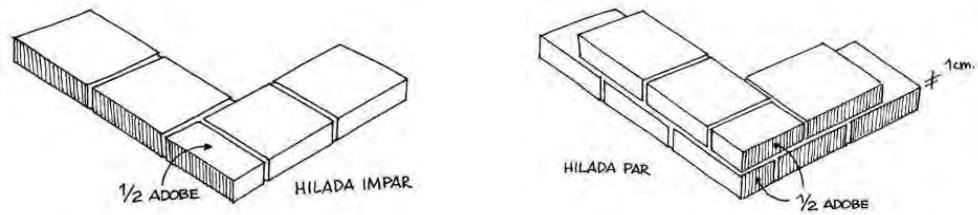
Detalles de emplantillado en esquina, encuentro tipo “L”
